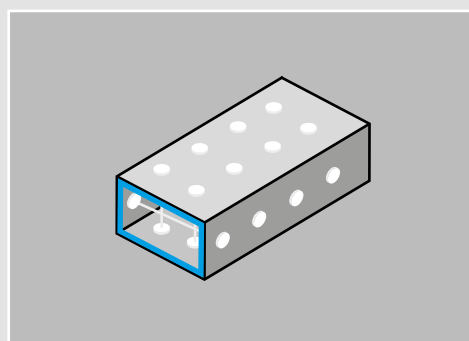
Applicazione con barre di rinforzo su tutte le pareti
